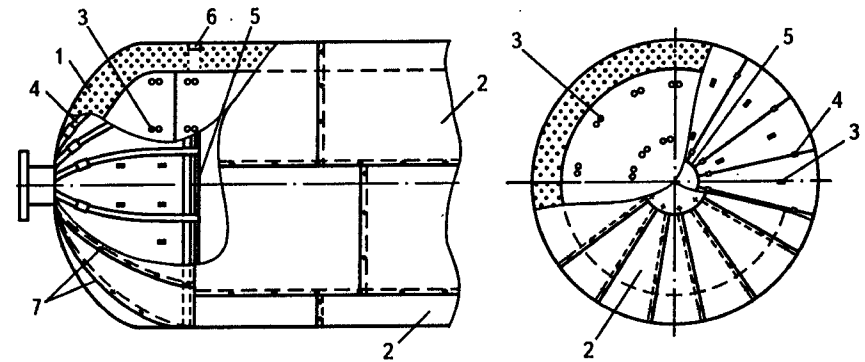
Изоляция днищ горизонтальных аппаратов матами теплоизоляционными с креплением штырями и с металлическим защитным покрытием: 1 — маты теплоизоляционные; 2 — защитное покрытие; 3 — штырь; 4 — бандаж с пряжкой; 5 — проволочное кольцо; 6 — опорное кольцо; 7 — винт
